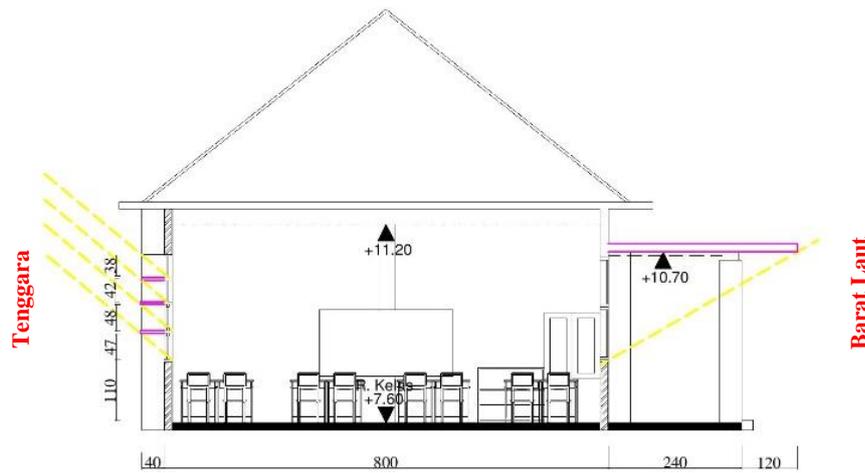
Tampak Tenggara dan Barat Laut Ruang Alternatif 2 Rekomendasi Eksternal II Ruang Kelas IPA
